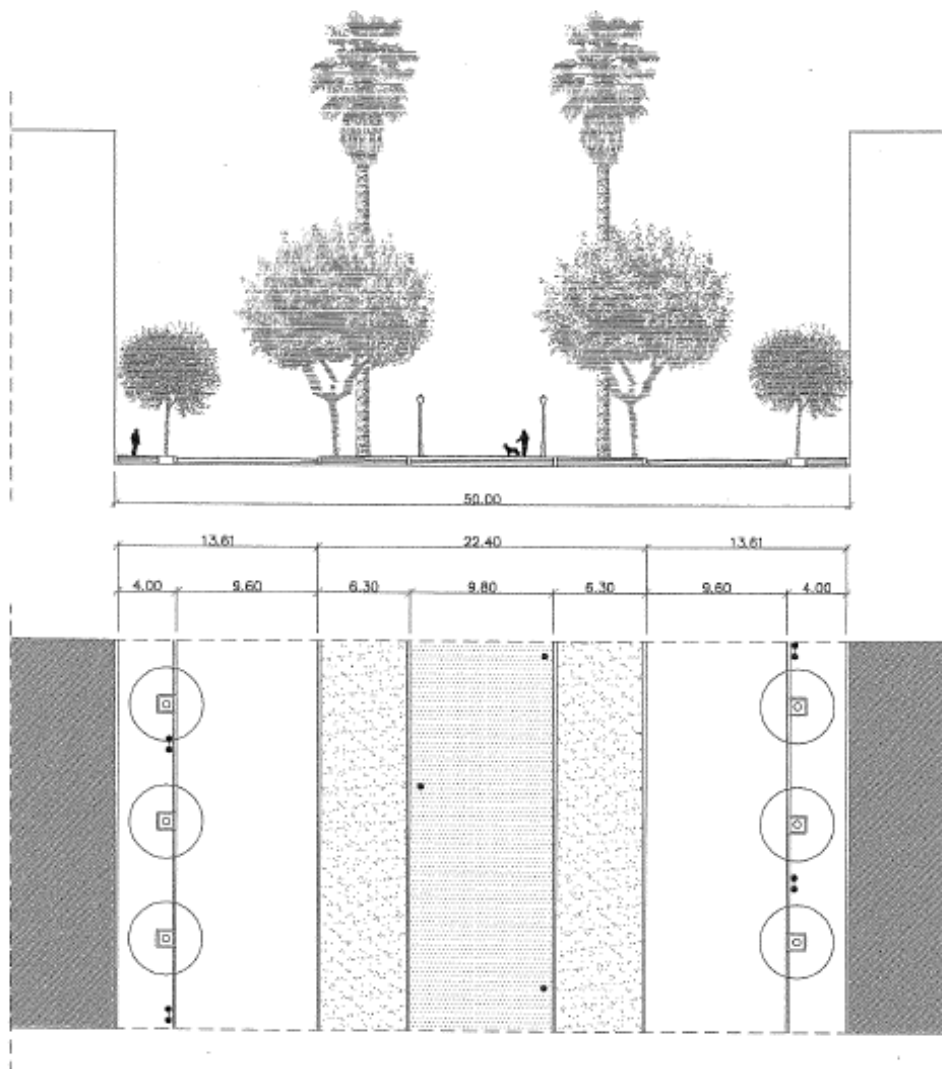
Detalle de la sección de la Gran Vía Marqués del Turia en la ficha de espacio urbano protegidos del Plan Especial de Protección y Ensanche Pla del Remei-Russafa Nord (2006). Toda intervención debe respetar las dinesiones y disposición de su sección viaria general, es decir su composición en dos bandejas laterales de tráfico rodado y peatonal, y una bandeja central como paseo arbolado, con las dimensiones generales de la sección dibujada en su ficha individual.
